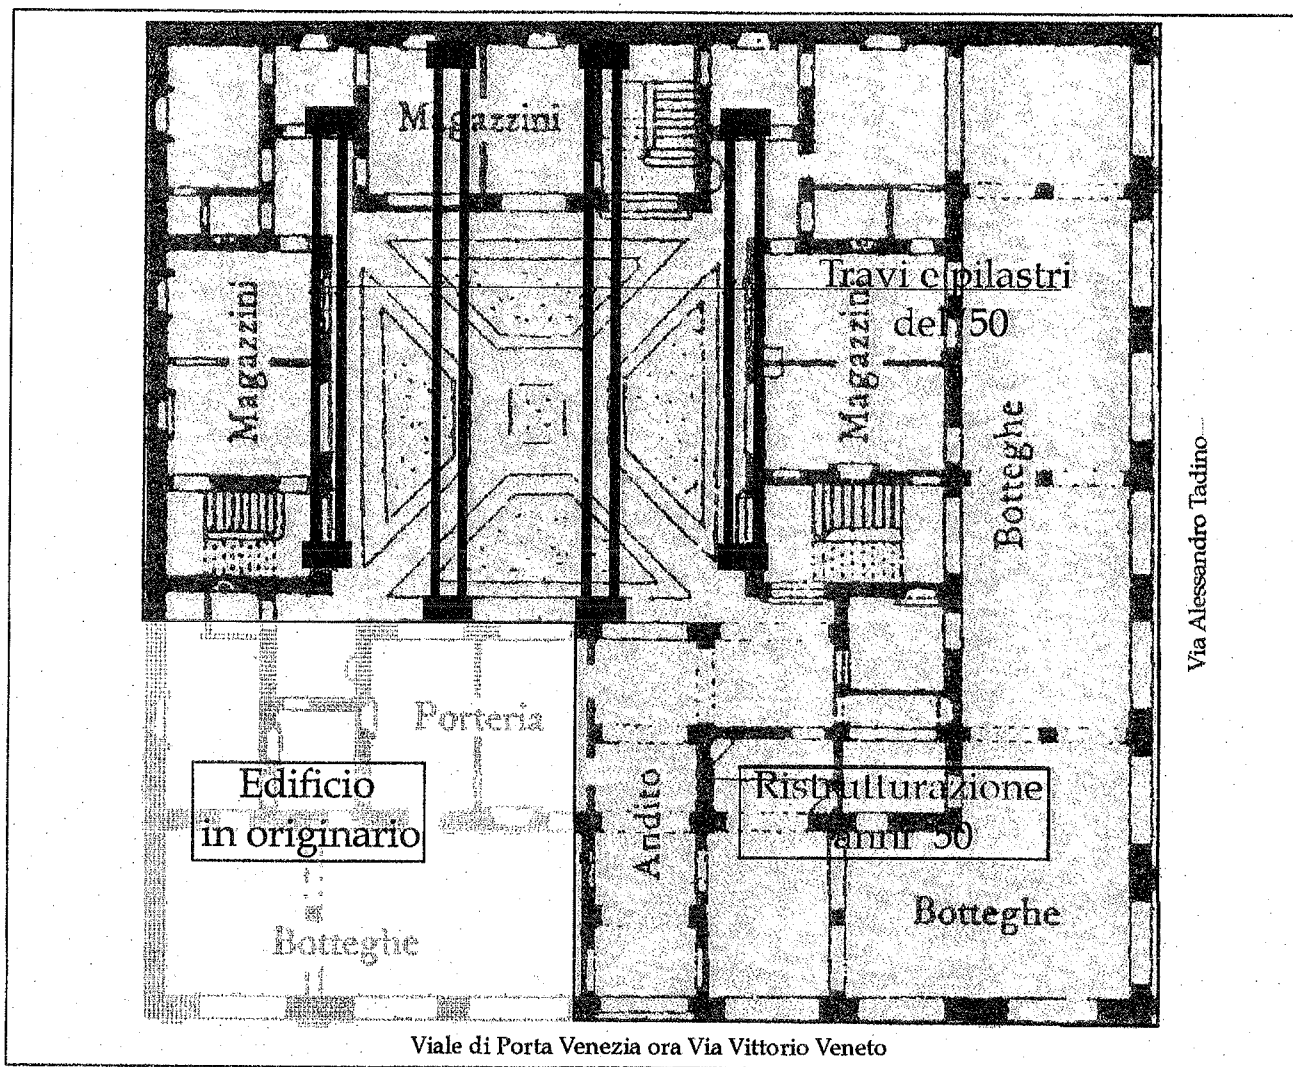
Edificio di Via Vittorio Veneto: Pianta del piano terreno
